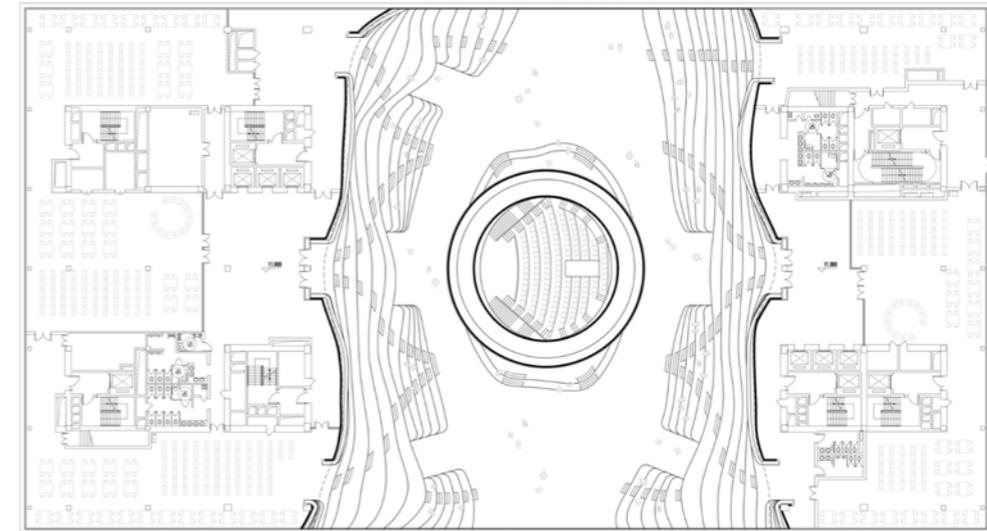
Grundriss der Tianjin Binhai Library, MVRDV
